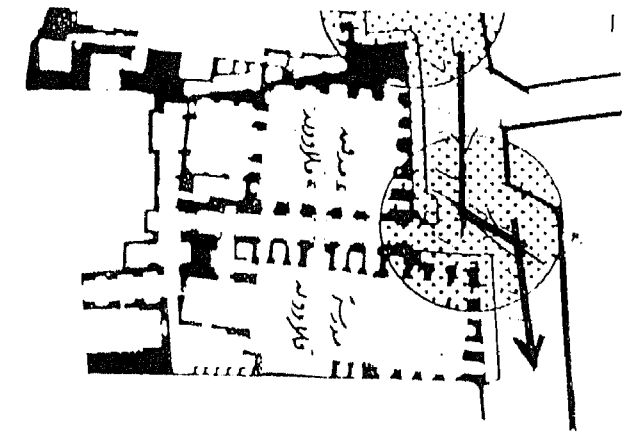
مسقط أفقى لمدخل مجموعة قلاوون
